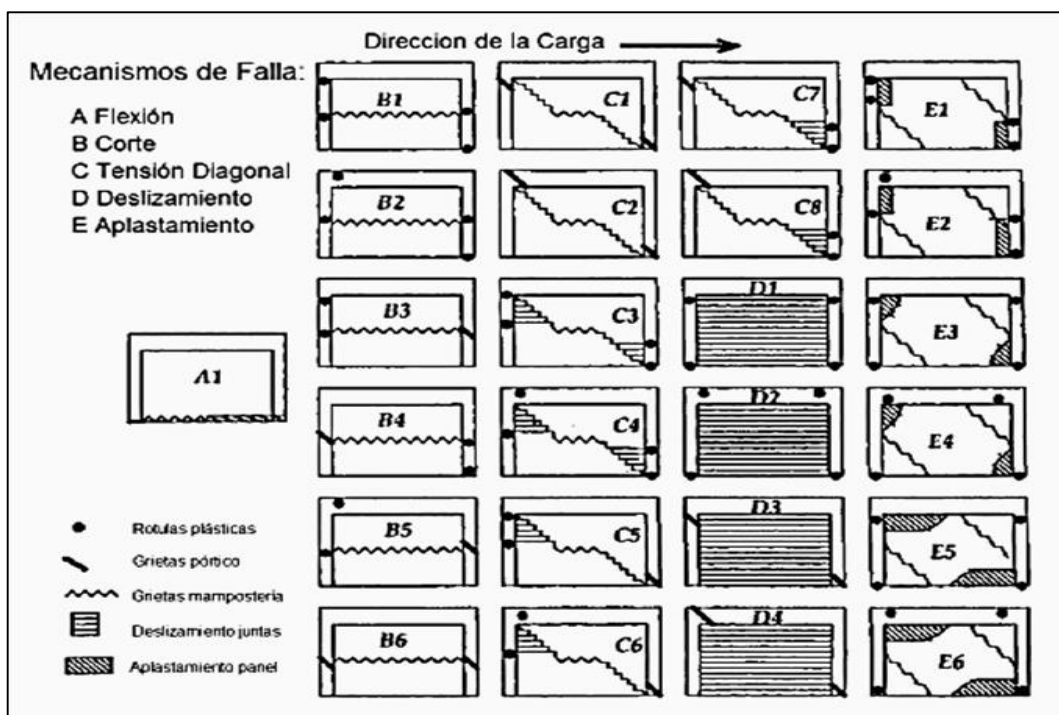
Mecanismo de fallas para pórticos rellenos con mampostería
